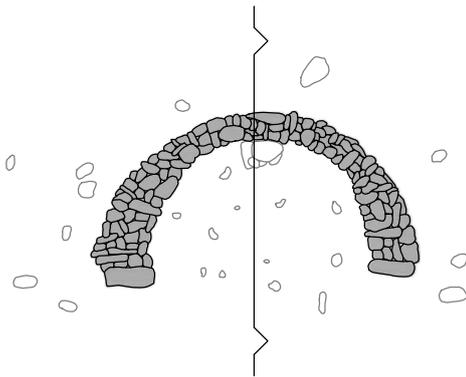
Planta de un paredón en Bermillo de Sayago. Fuente: Elaboración propia.
